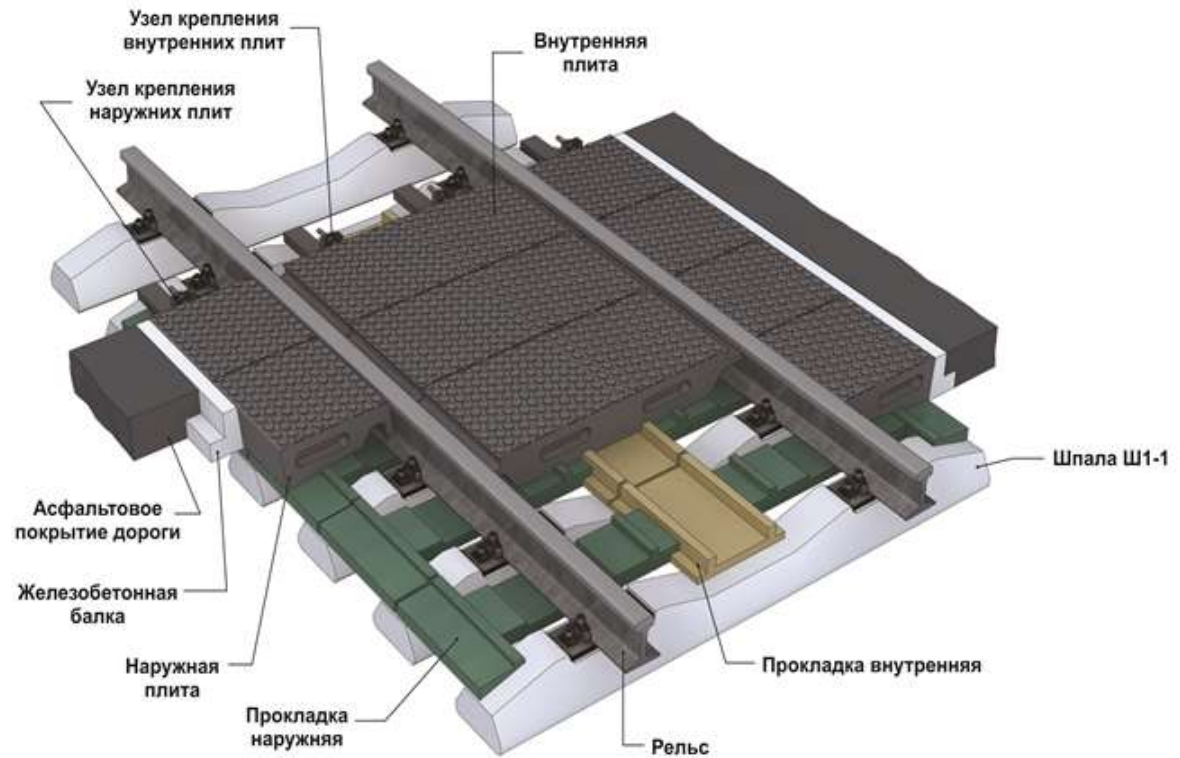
Устройство резинокордового настила на железобетонных шпалах
